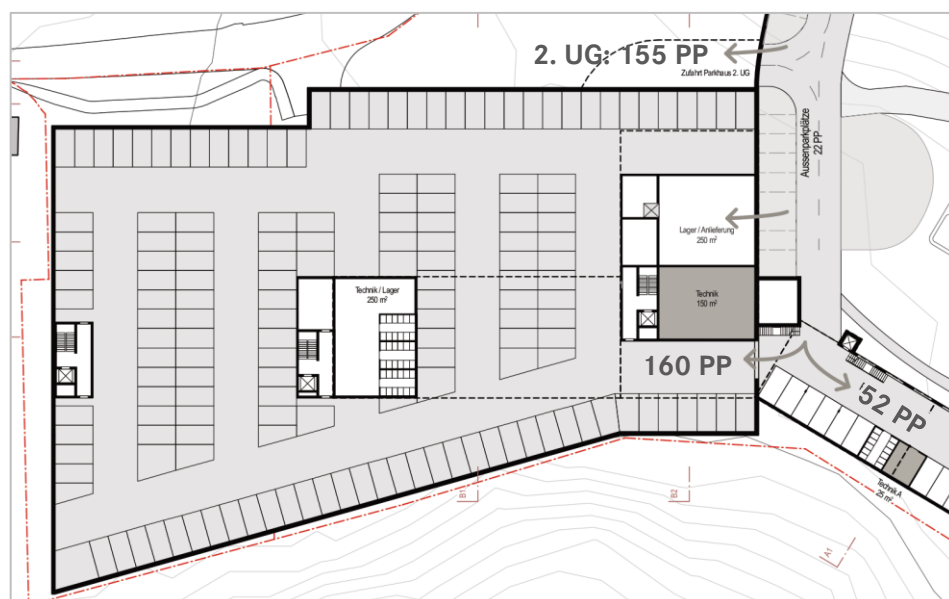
Erschliessung des Areals mit Anschlüssen an Kantonstrasse und Parkierungsanlagen
